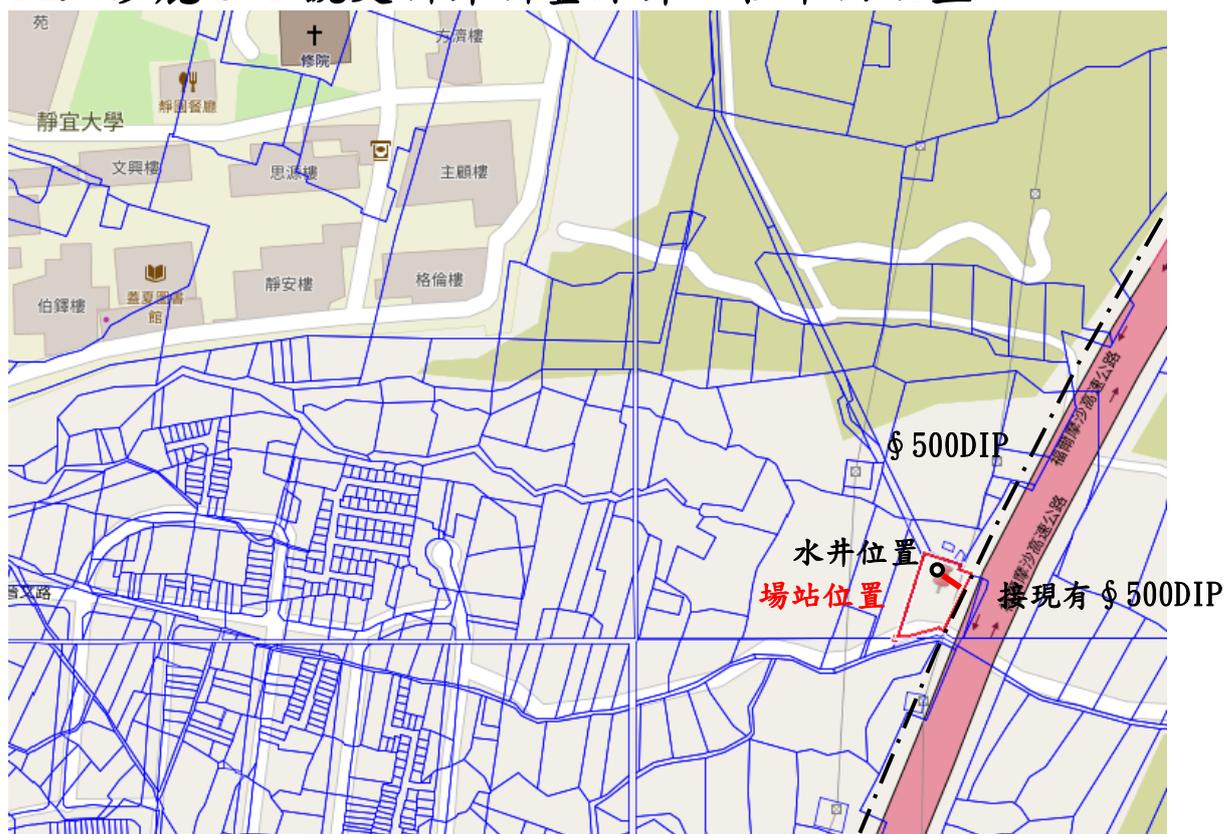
沙鹿 5-1 號更新井新鑿深井工程平面配置示意圖
